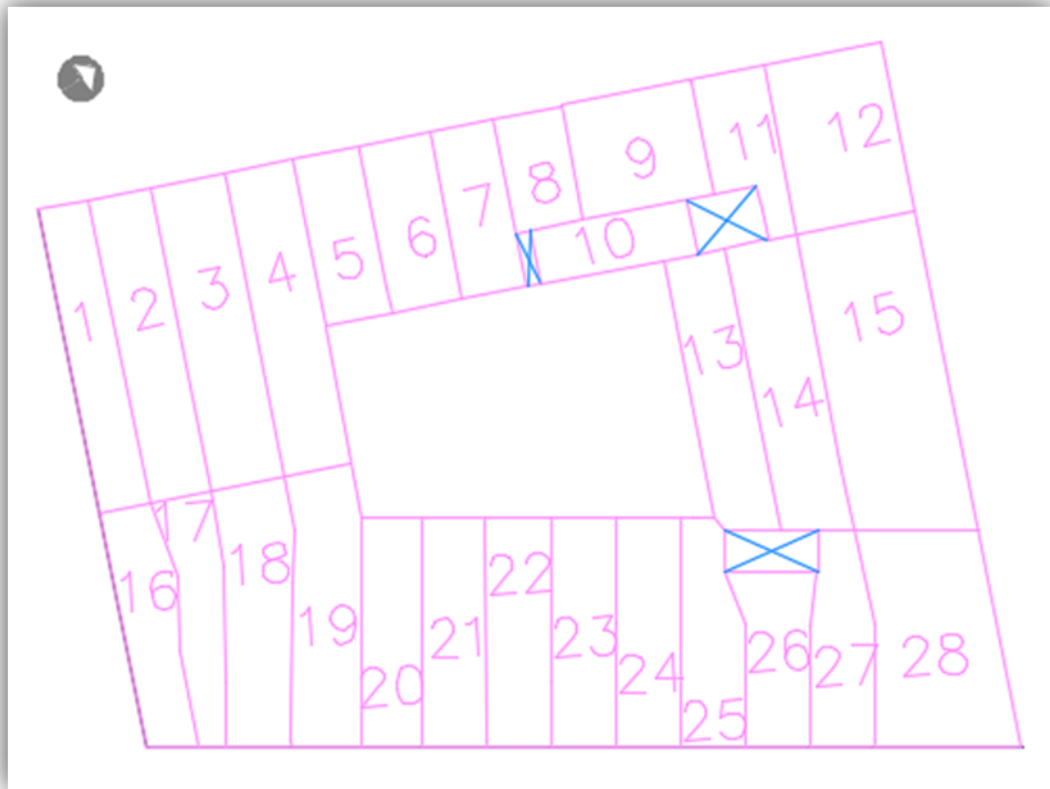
División de paños de la losa. Elaborado por la autora.
